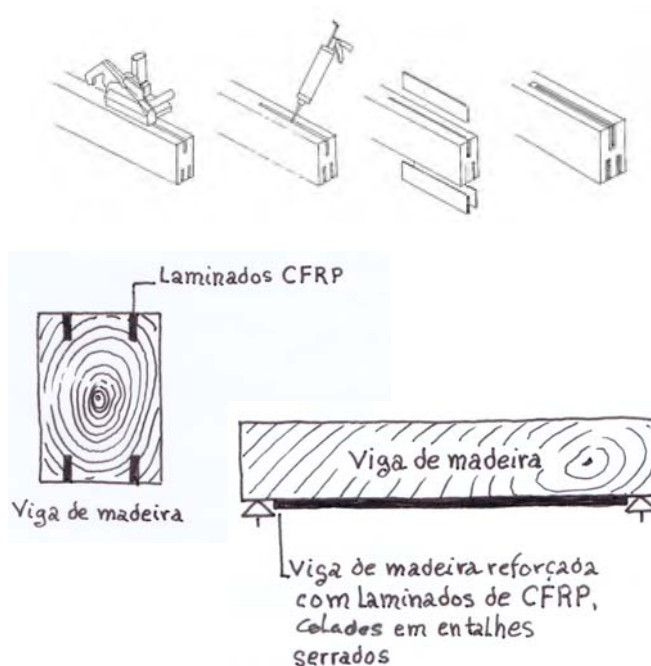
| Reforço de elemento de viga em madeira com laminados CFRP (adaptado de [14, 21])
